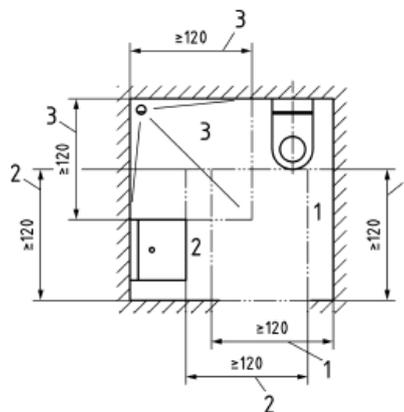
Mustergrundriss barrierefreie Wohnungen
